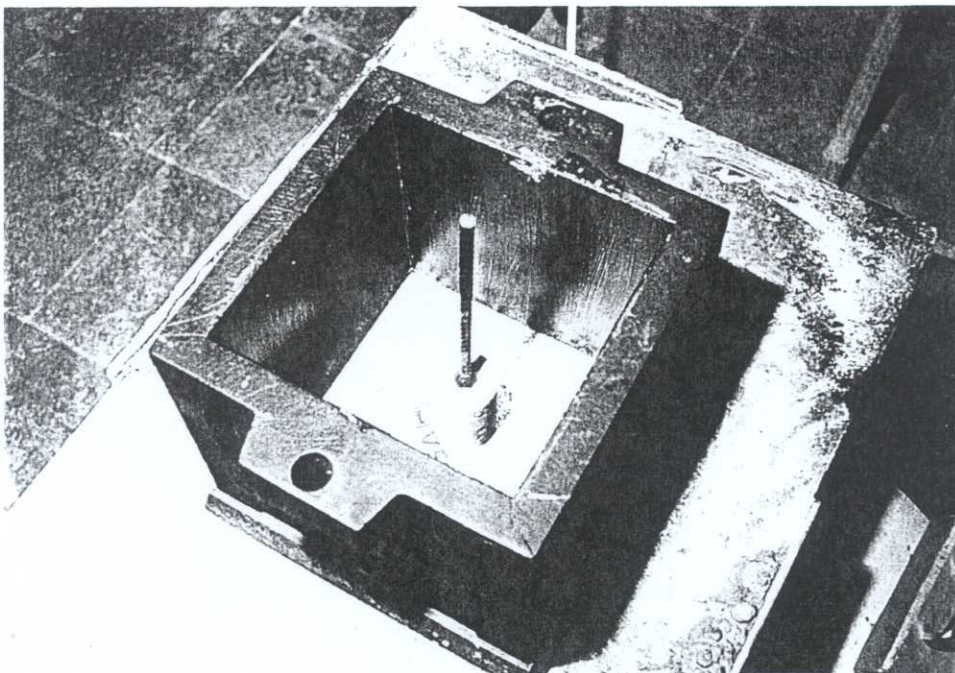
Ansicht des Probekörpers und des Abstandhalters vor dem Einbringen des Betons
